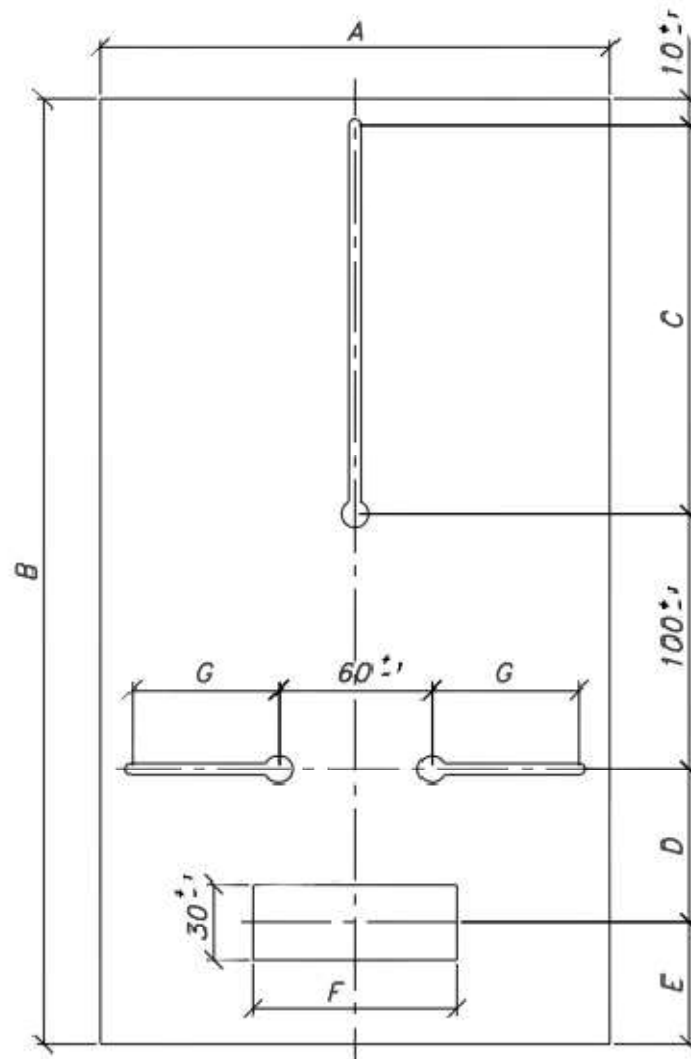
Panel de montaje de contadores. Dimensiones en mm
